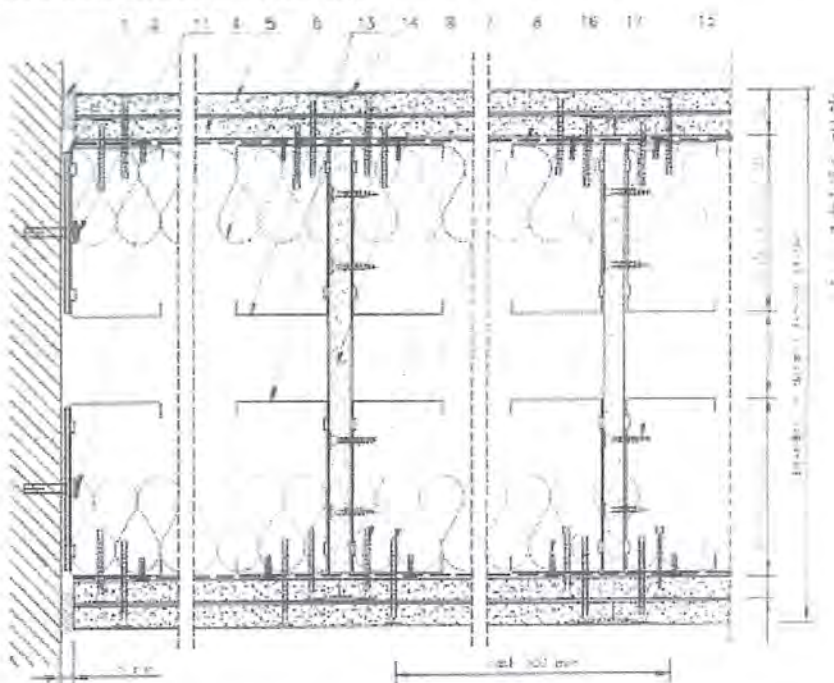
Vertikal- und Horizontalschnitt einbruchshemmender nichttragender zweilagiger Trennwände mit doppeltem + Stahlblech 1,0 mm (beidseitig) – für Installationswände
